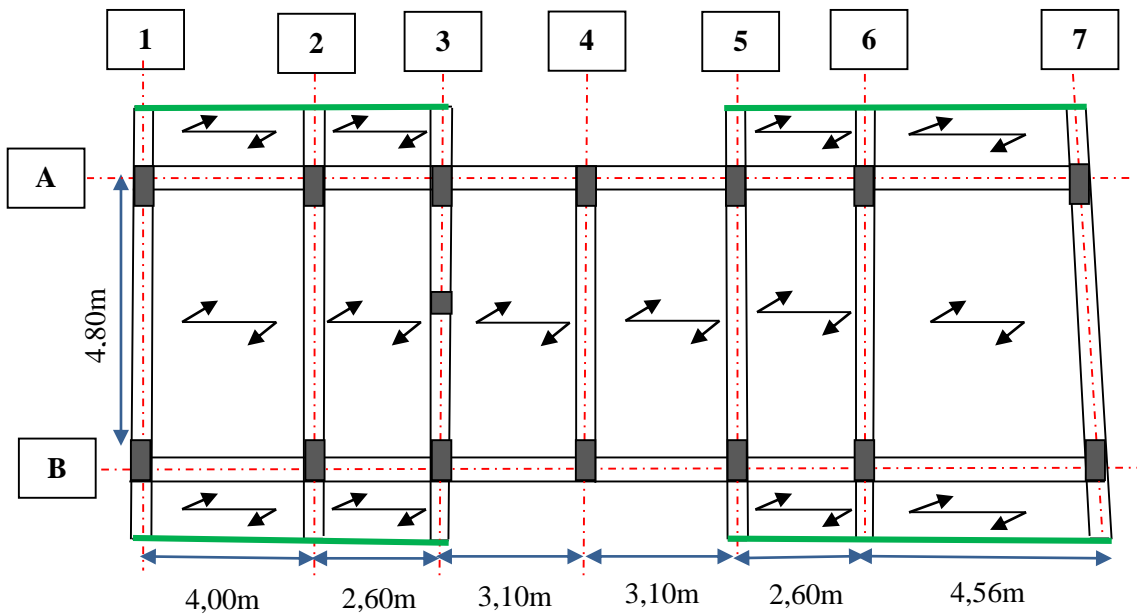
Plane de disposition des poutrelles du duplex niveau 2
